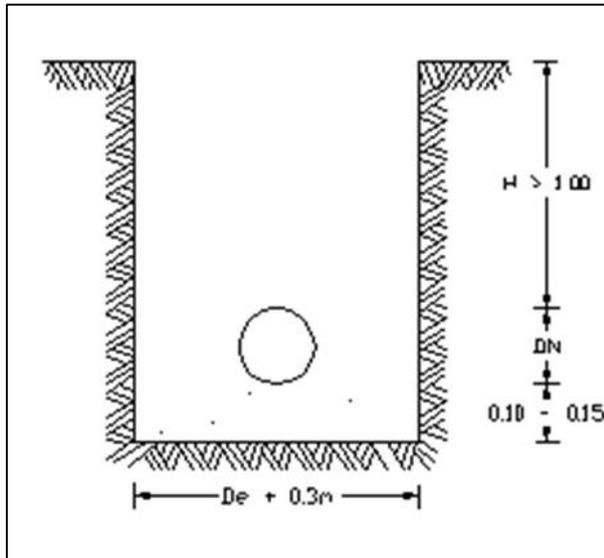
Perfil de alcantarillado convencional (SEDAPAL)
